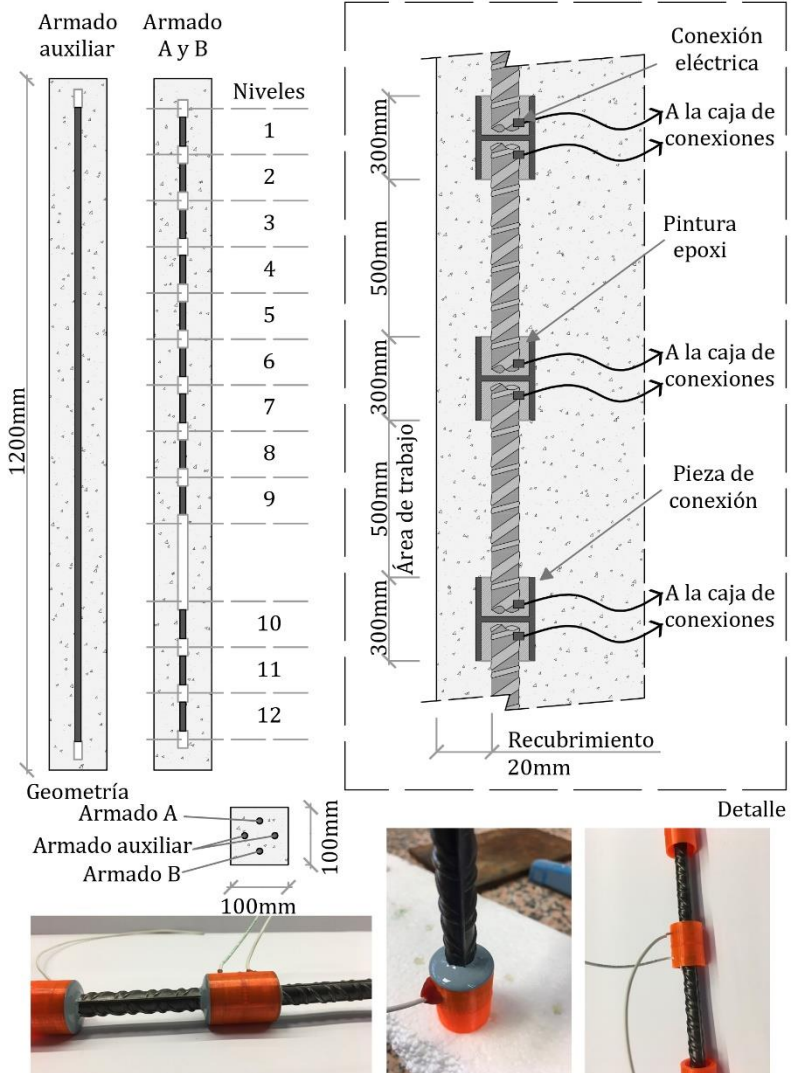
10- Geometría de los pilares fabricados, detalle del armado segmentado y montaje de las armaduras. Elaboración propia.
